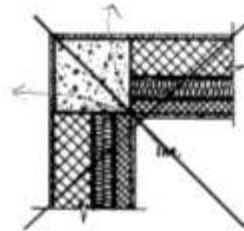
A-1: Pilastro d'angolo: ponte termico non corretto.
